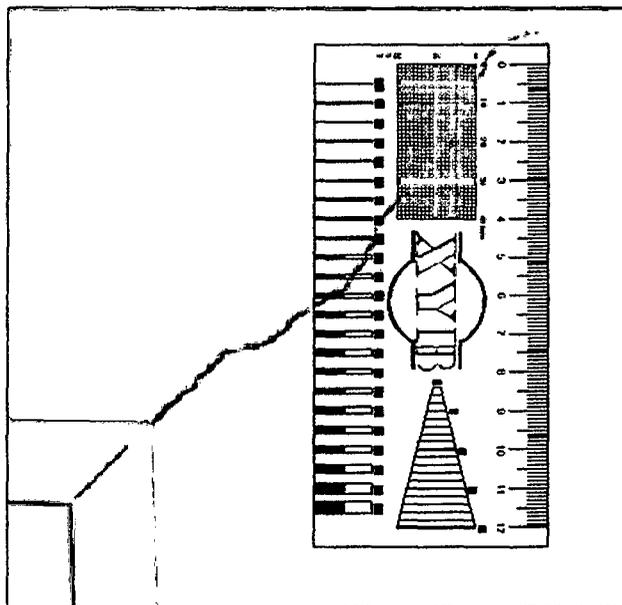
Cálculo de la pendiente de la fisura
